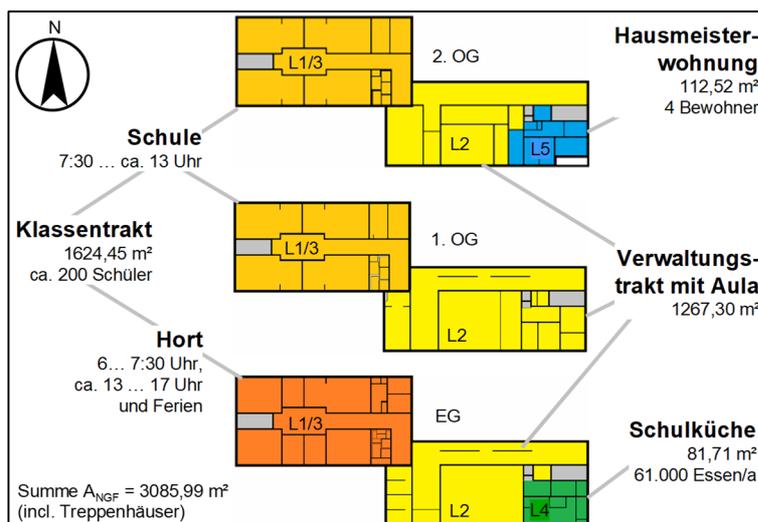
Vereinfachtes Grundrisschema mit Nutzungsbereichen und Lüftungszonen (L)
